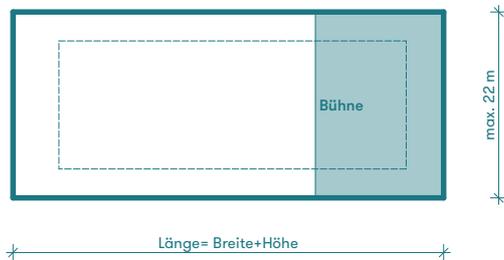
Grundriss-Konzept Schuhschachtelstil
